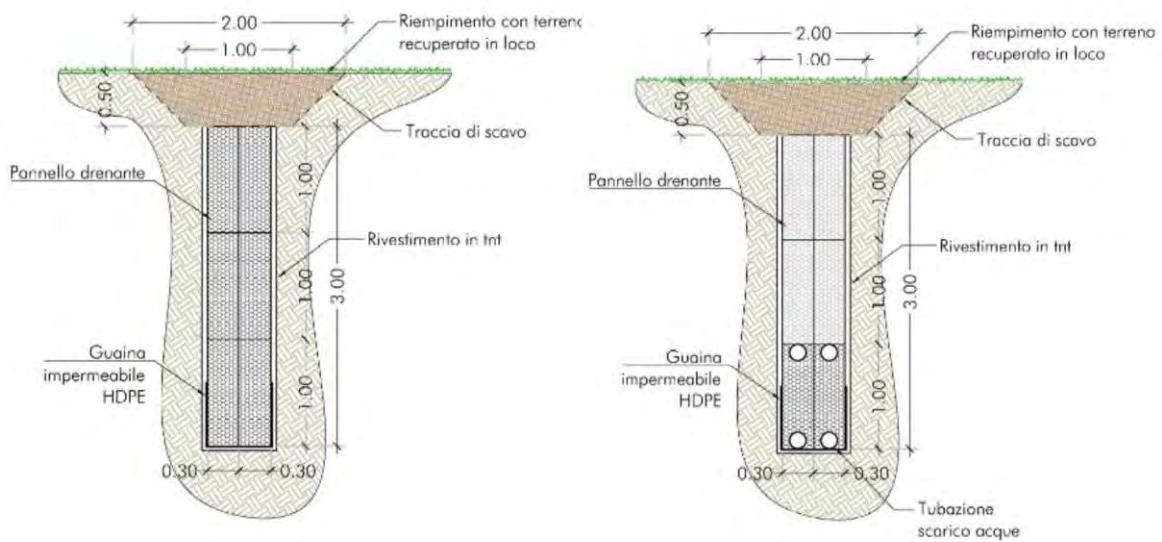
Esempi di regimazione idraulica profonda delle acque con sistemazione dei recapiti superficiali, mediante trincee drenanti con sezione tipo intermedia (a sinistra) e tipo sbocco (a destra).
